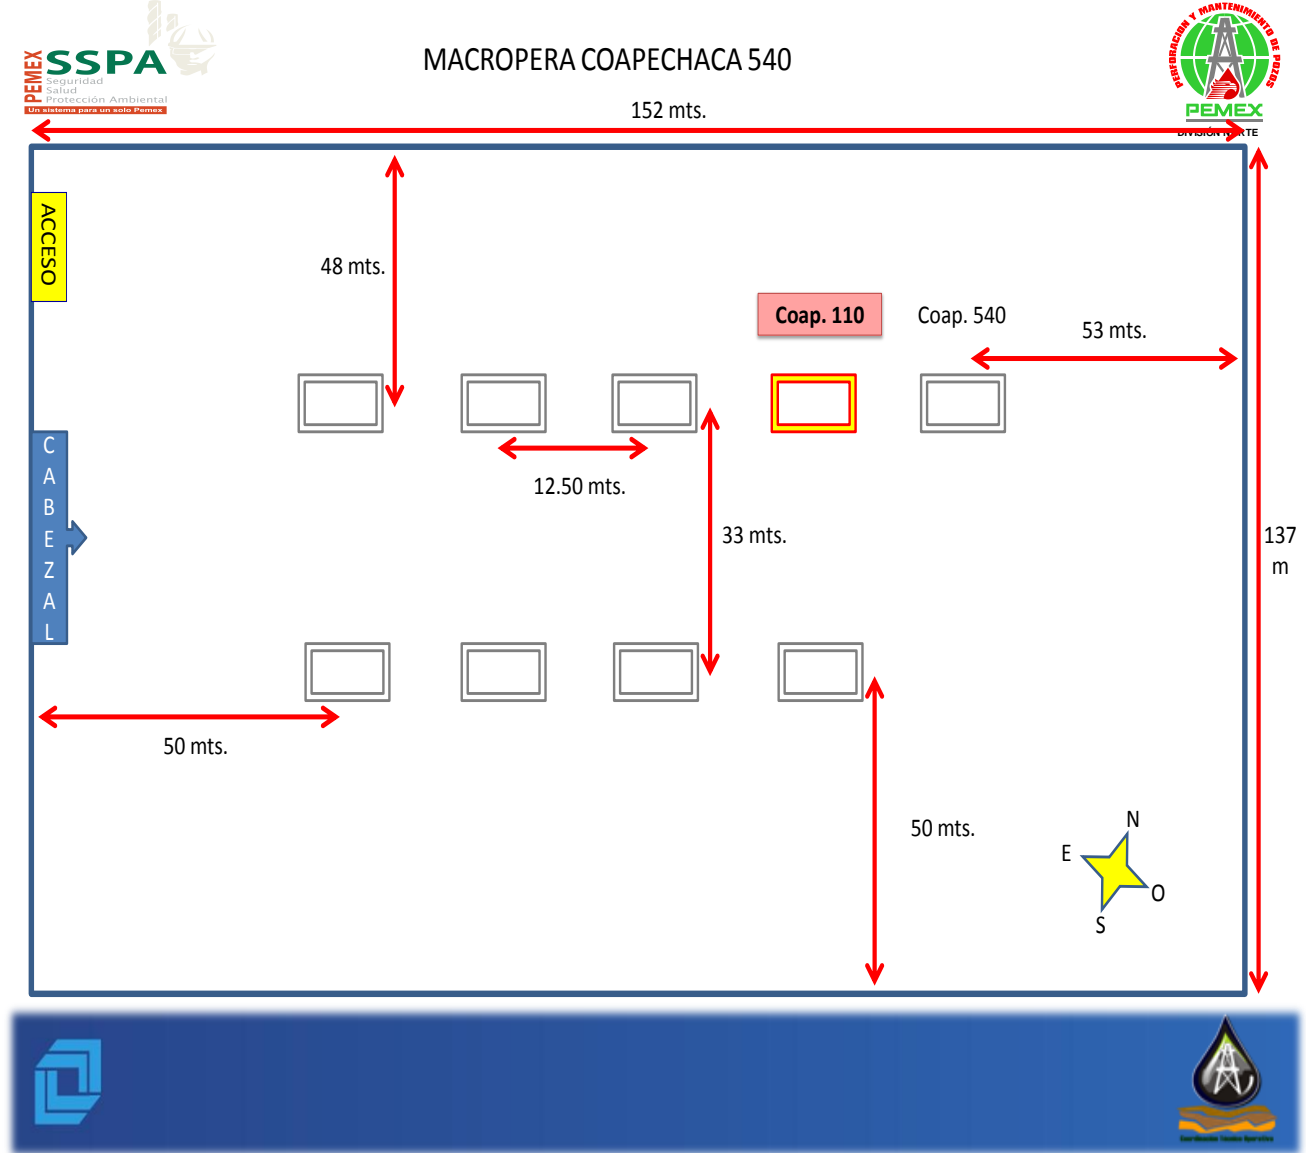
Croquis de la Macropera Coapechaca 540.¹
